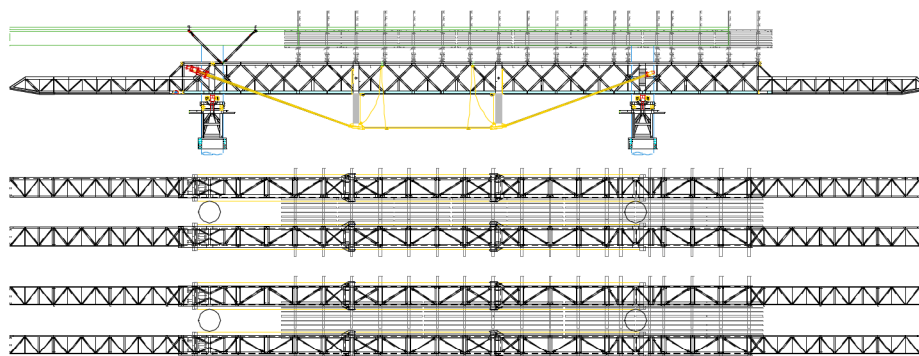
Alçado e planta do cimbre em posição de betonagem
